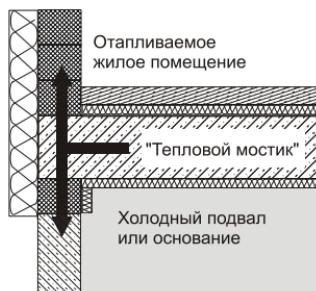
"Тепловой мостик" в месте стыка наружной стены с подвальным перекрытием и подвальной стеной или с плитой основания и фундаментной стеной
